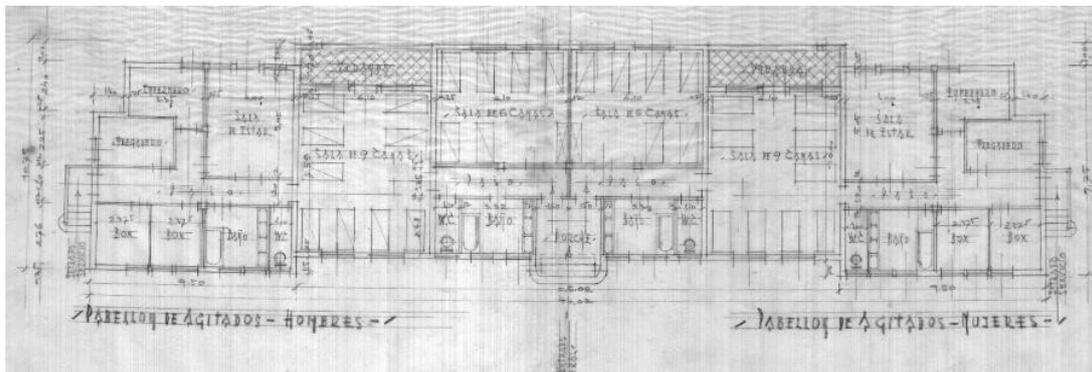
Planta del Proyecto original de 1931.
